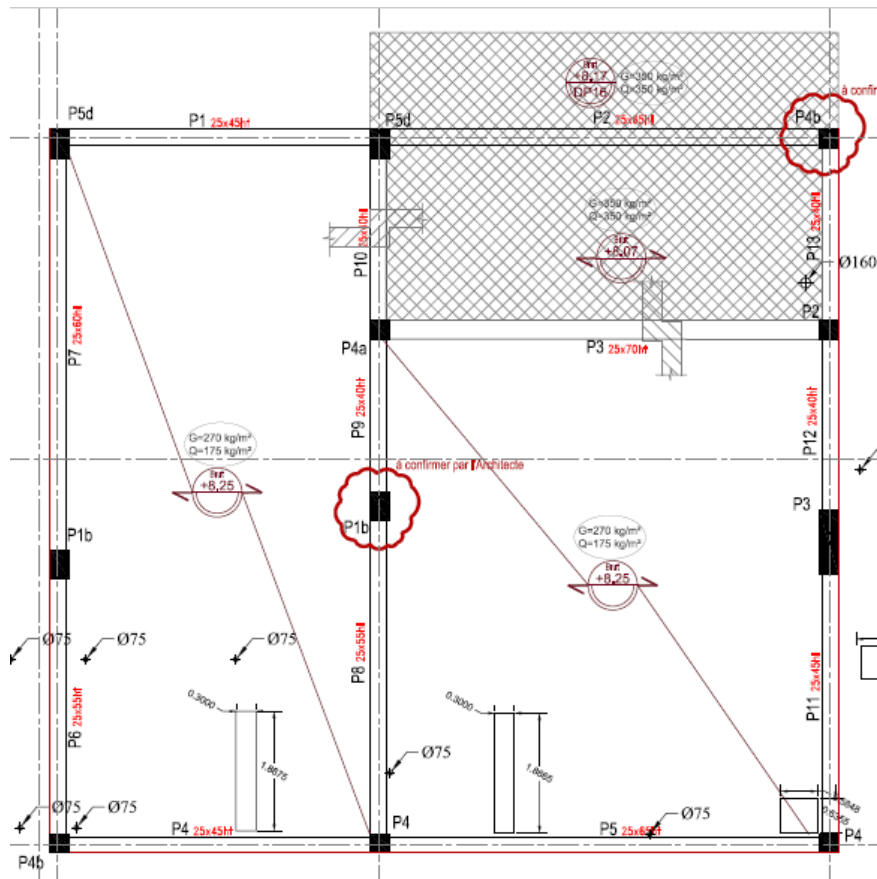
PLAN DE COFFRAGE DALLE PLEINE JOINT 23 PH R+1
